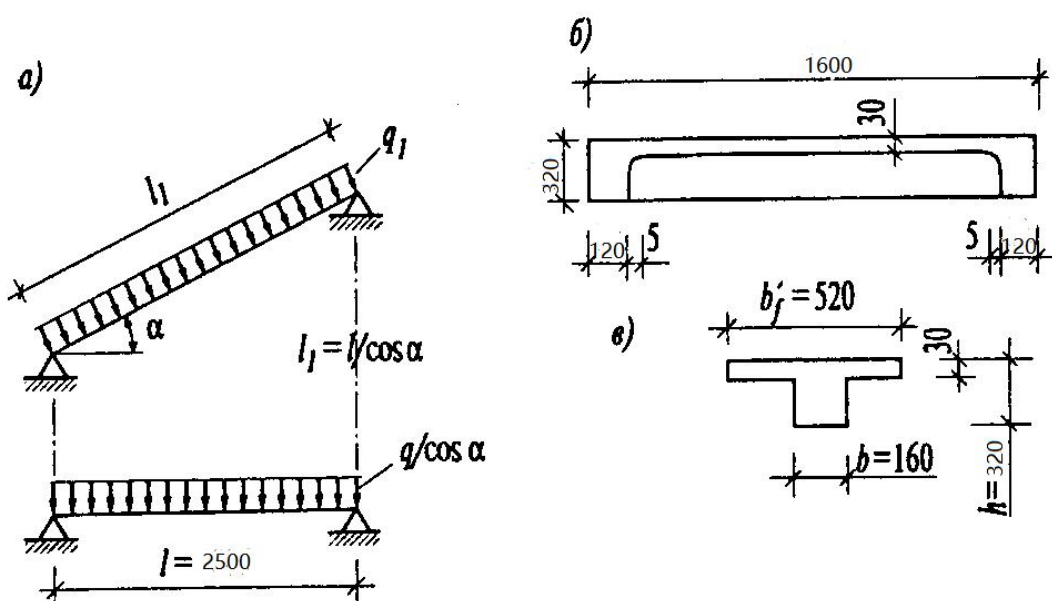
Расчетная схема, реальное и приведенное поперечные сечения.
